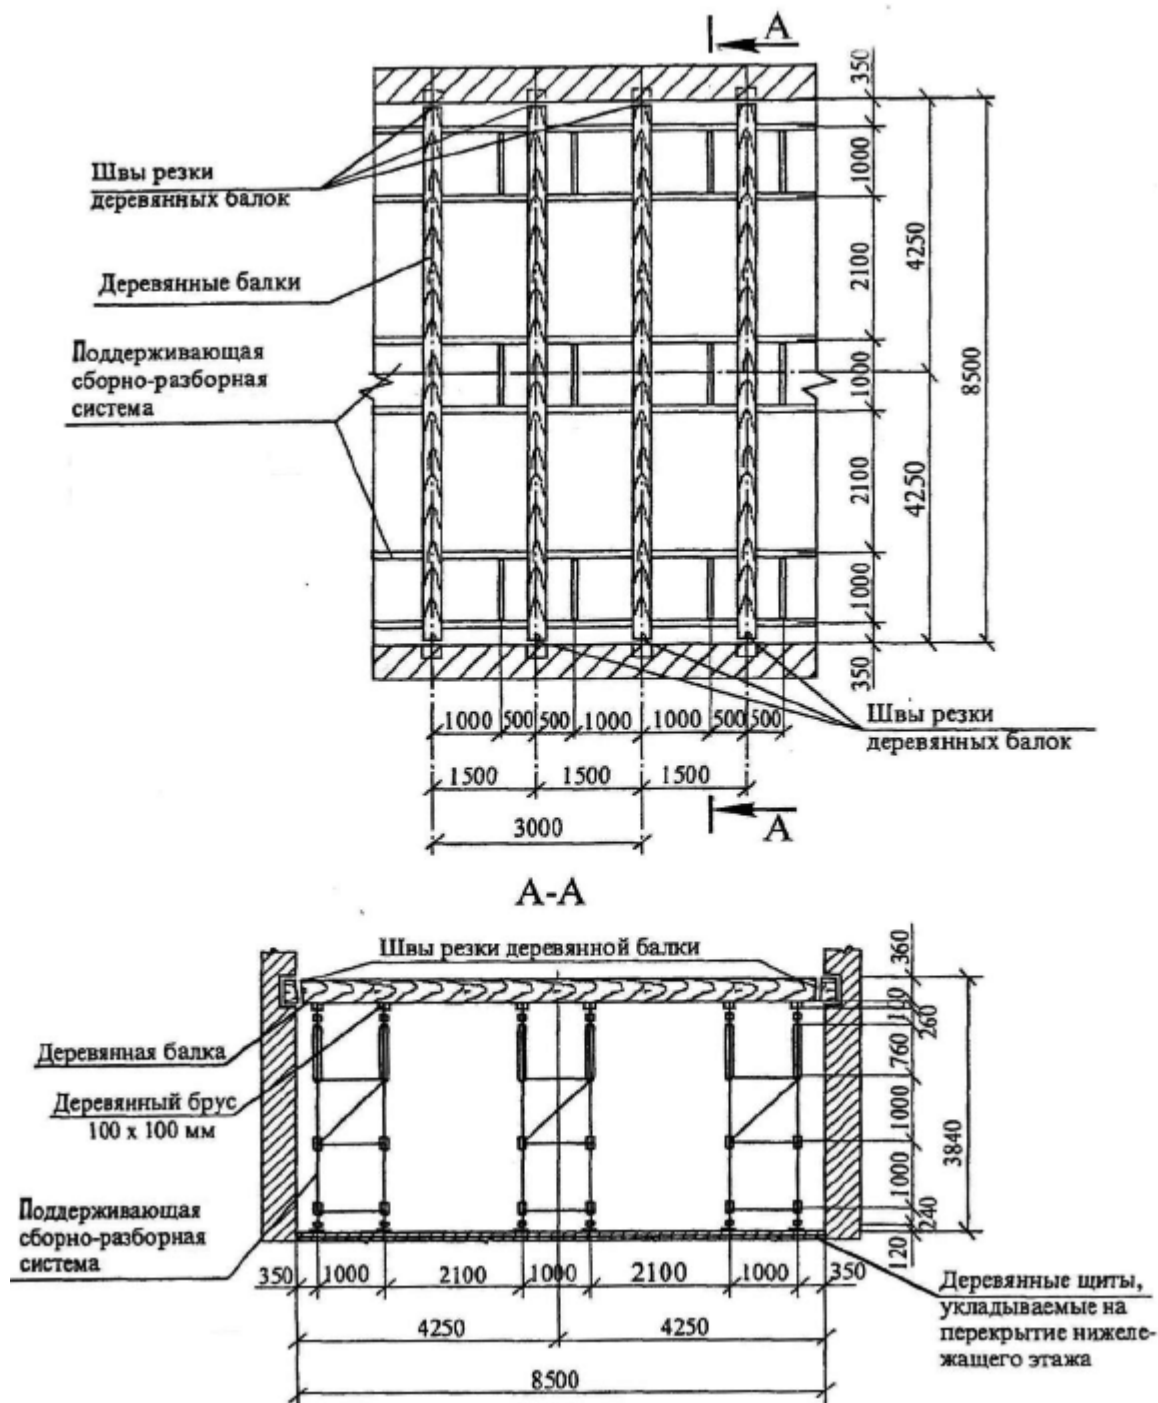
Схема разборки междуэтажного перекрытия по деревянным балкам
